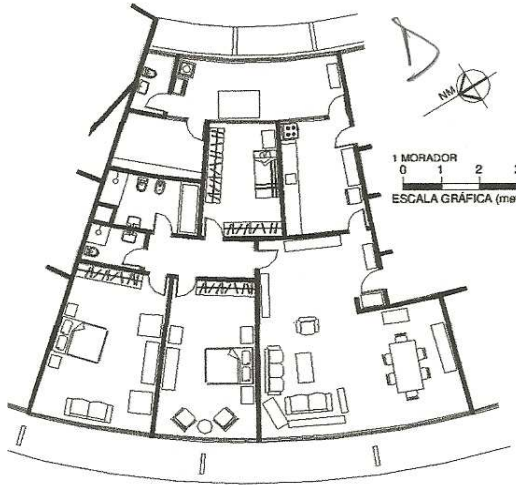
Planta baixa de apartamento do bloco D (Fonte: GALVÃO e ORNSTEIN, 2008, p.6)
